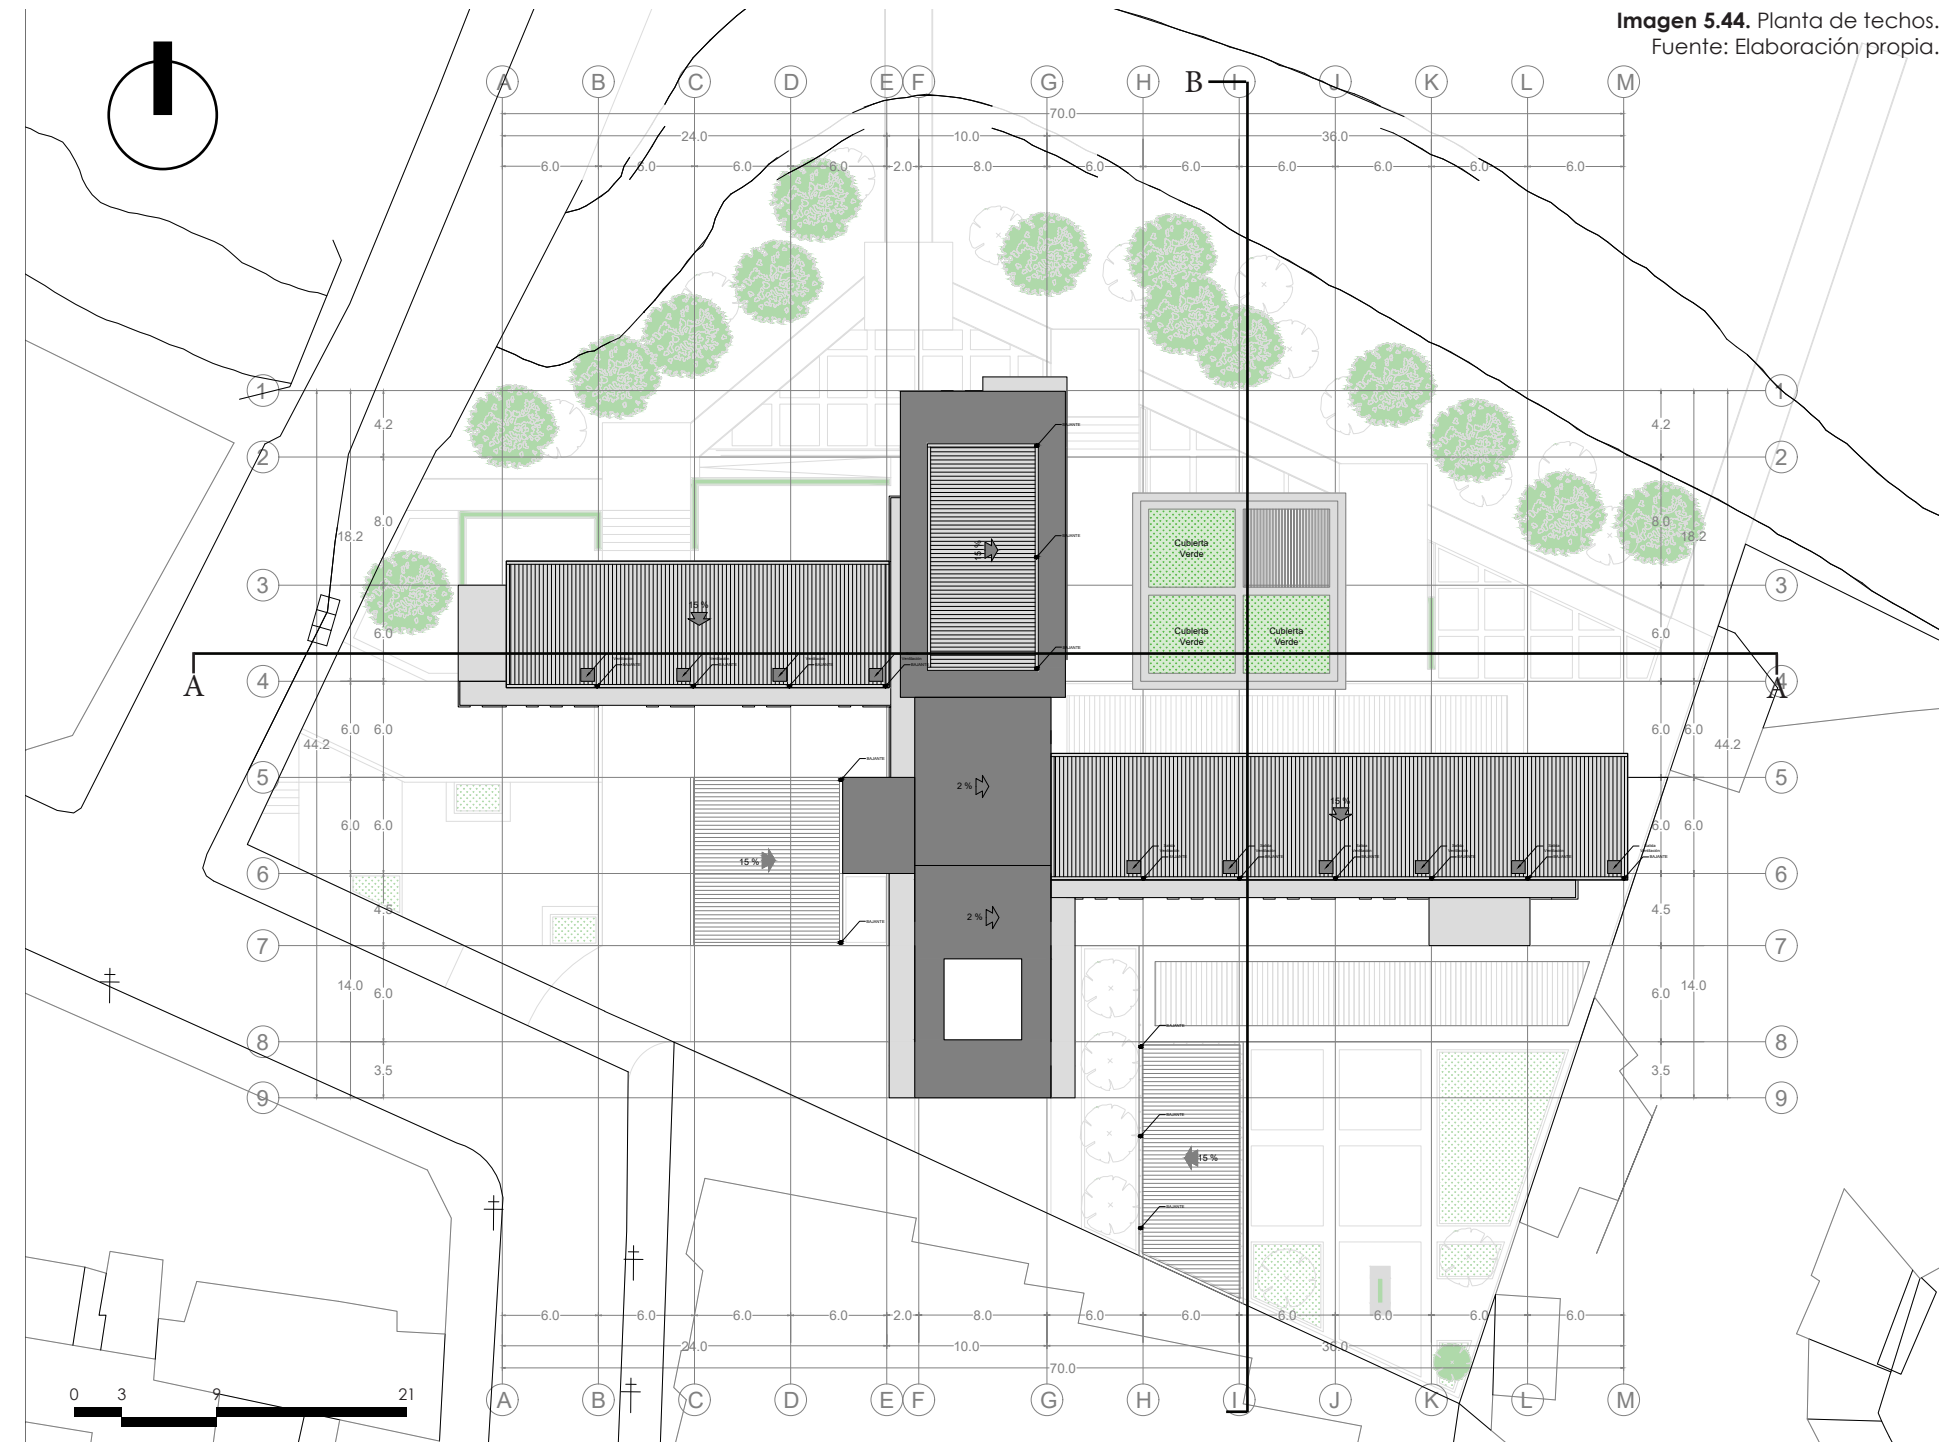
Planta de techos. Fuente: Elaboración propia.
